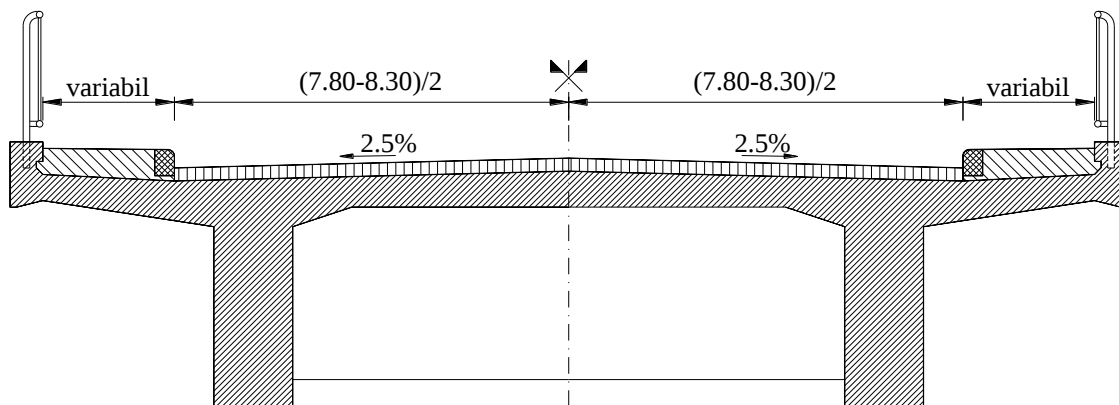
Secțiune aplicată la podurile pe grinzi din beton armat, realizate monolit.
